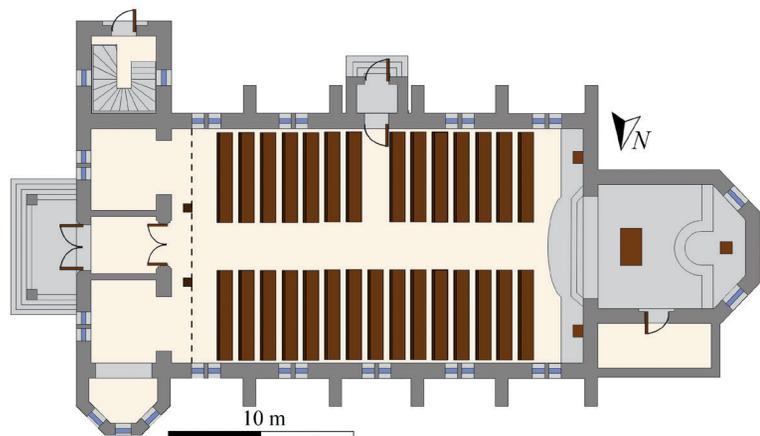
Grundriss der St. Maximilian Kirche (fs).
